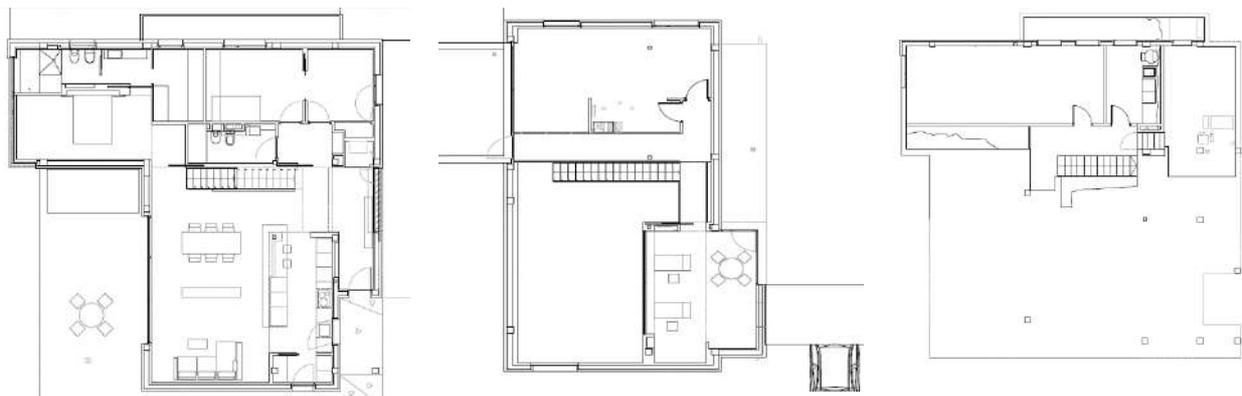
Detalles de plantas: de izquierda a derecha: planta principal, planta superior y planta sótano
